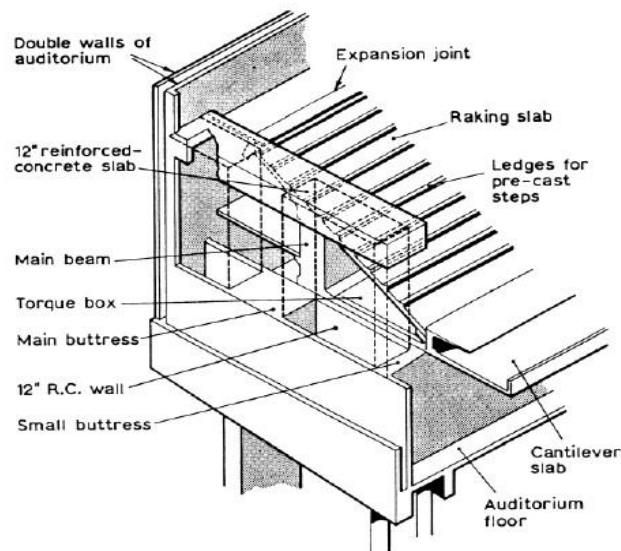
(a) - Vista do caixão triangular para suporte da laje em consola no Royal Festival Hall [44]
